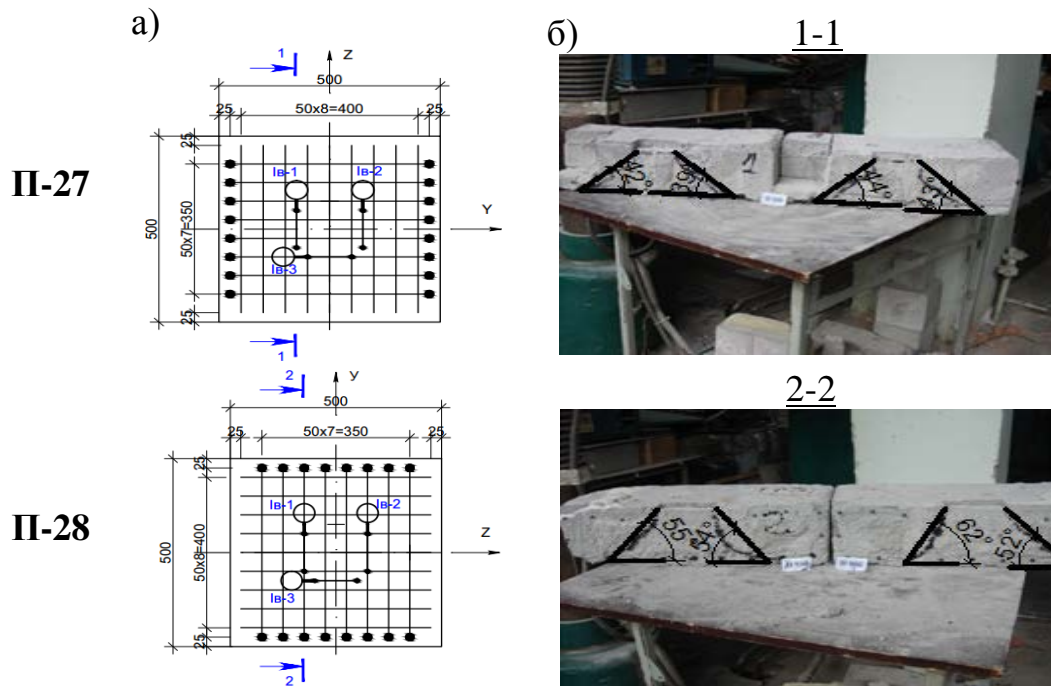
Пінобетонні армовані плити марок П-27, П-28 після випробувань:
